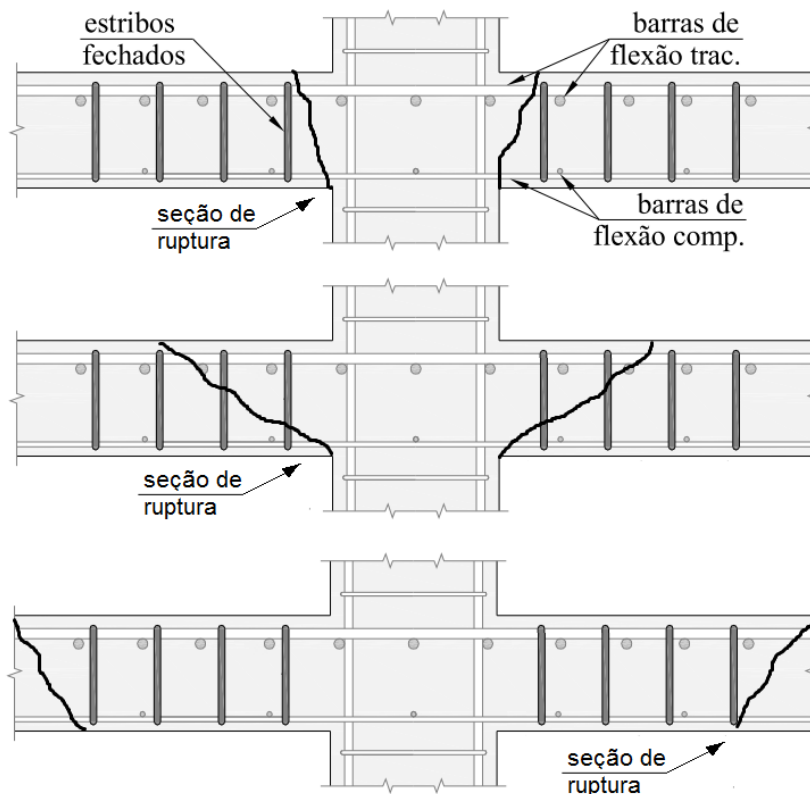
Regiões de ruptura em lajes com armadura de cisalhamento.
